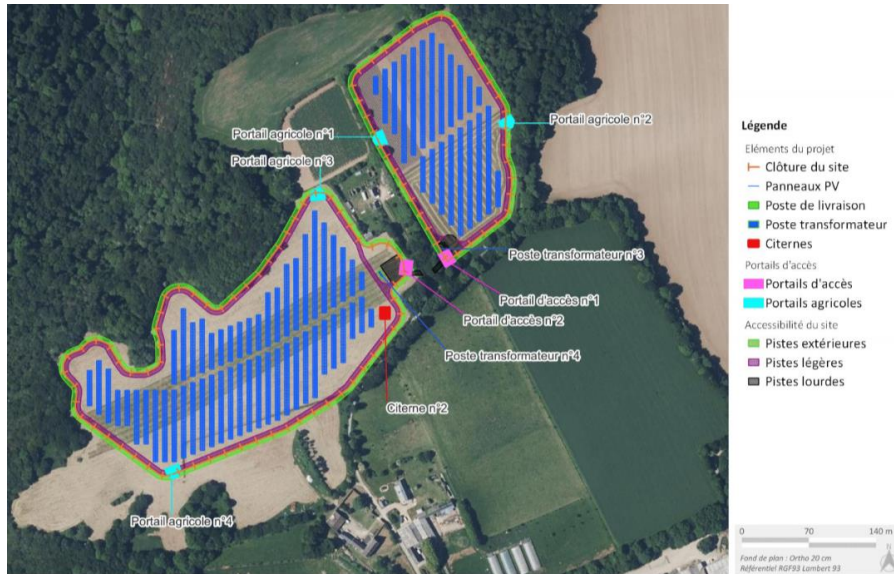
Plan de masse du projet agrivoltaïque de Pleyber-Christ – secteur Nord (Néodyme, GLHD, 2023)
